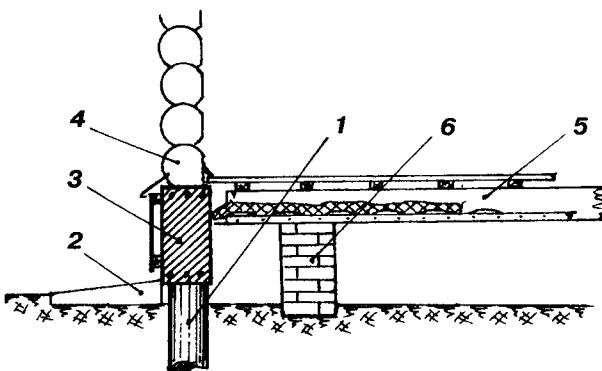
Разделение опор под стены и перекрытие в деревянном доме:
